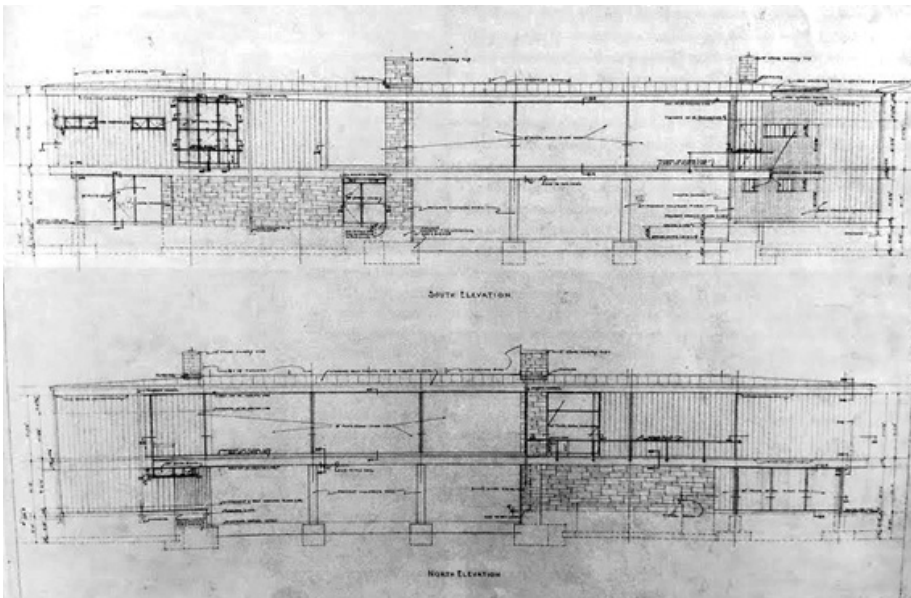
Alzados sur y norte del proyecto definitivo de la Resor House.
